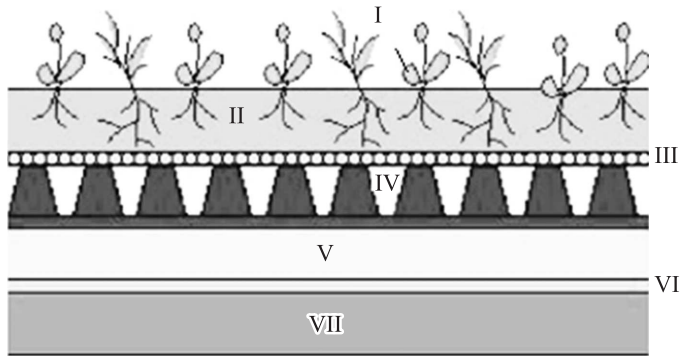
Сплошная кровельная конструкция с озеленением в виде основного покрытия
